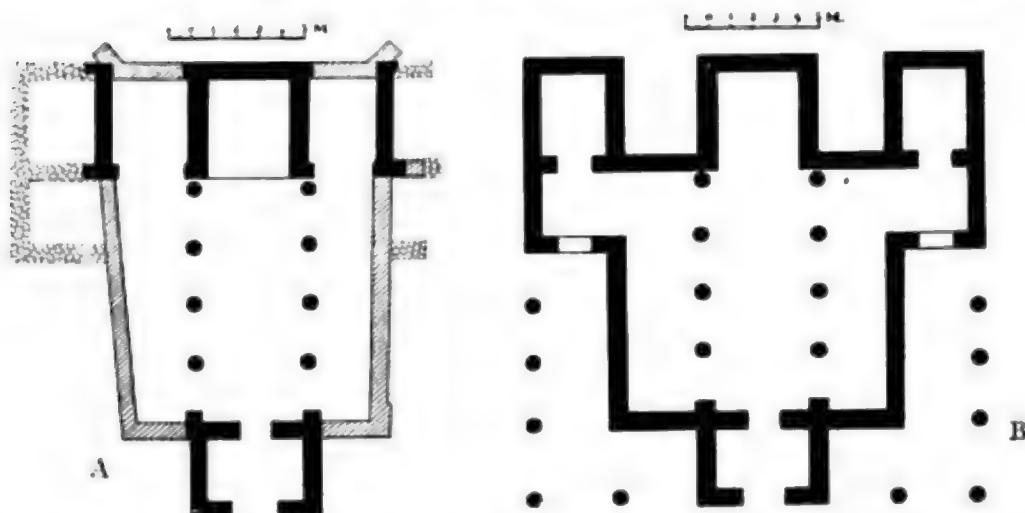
Planta actual de San Juan de Baños (A) y proyecto de reconstrucción (B).
